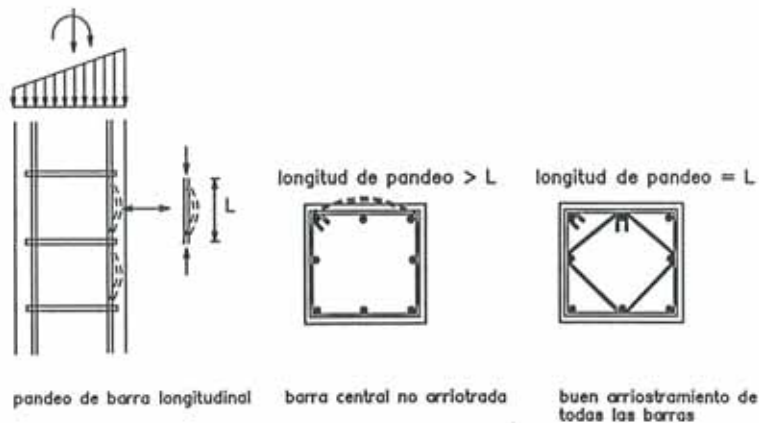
Fallo por pandeo local del refuerzo longitudinal.
